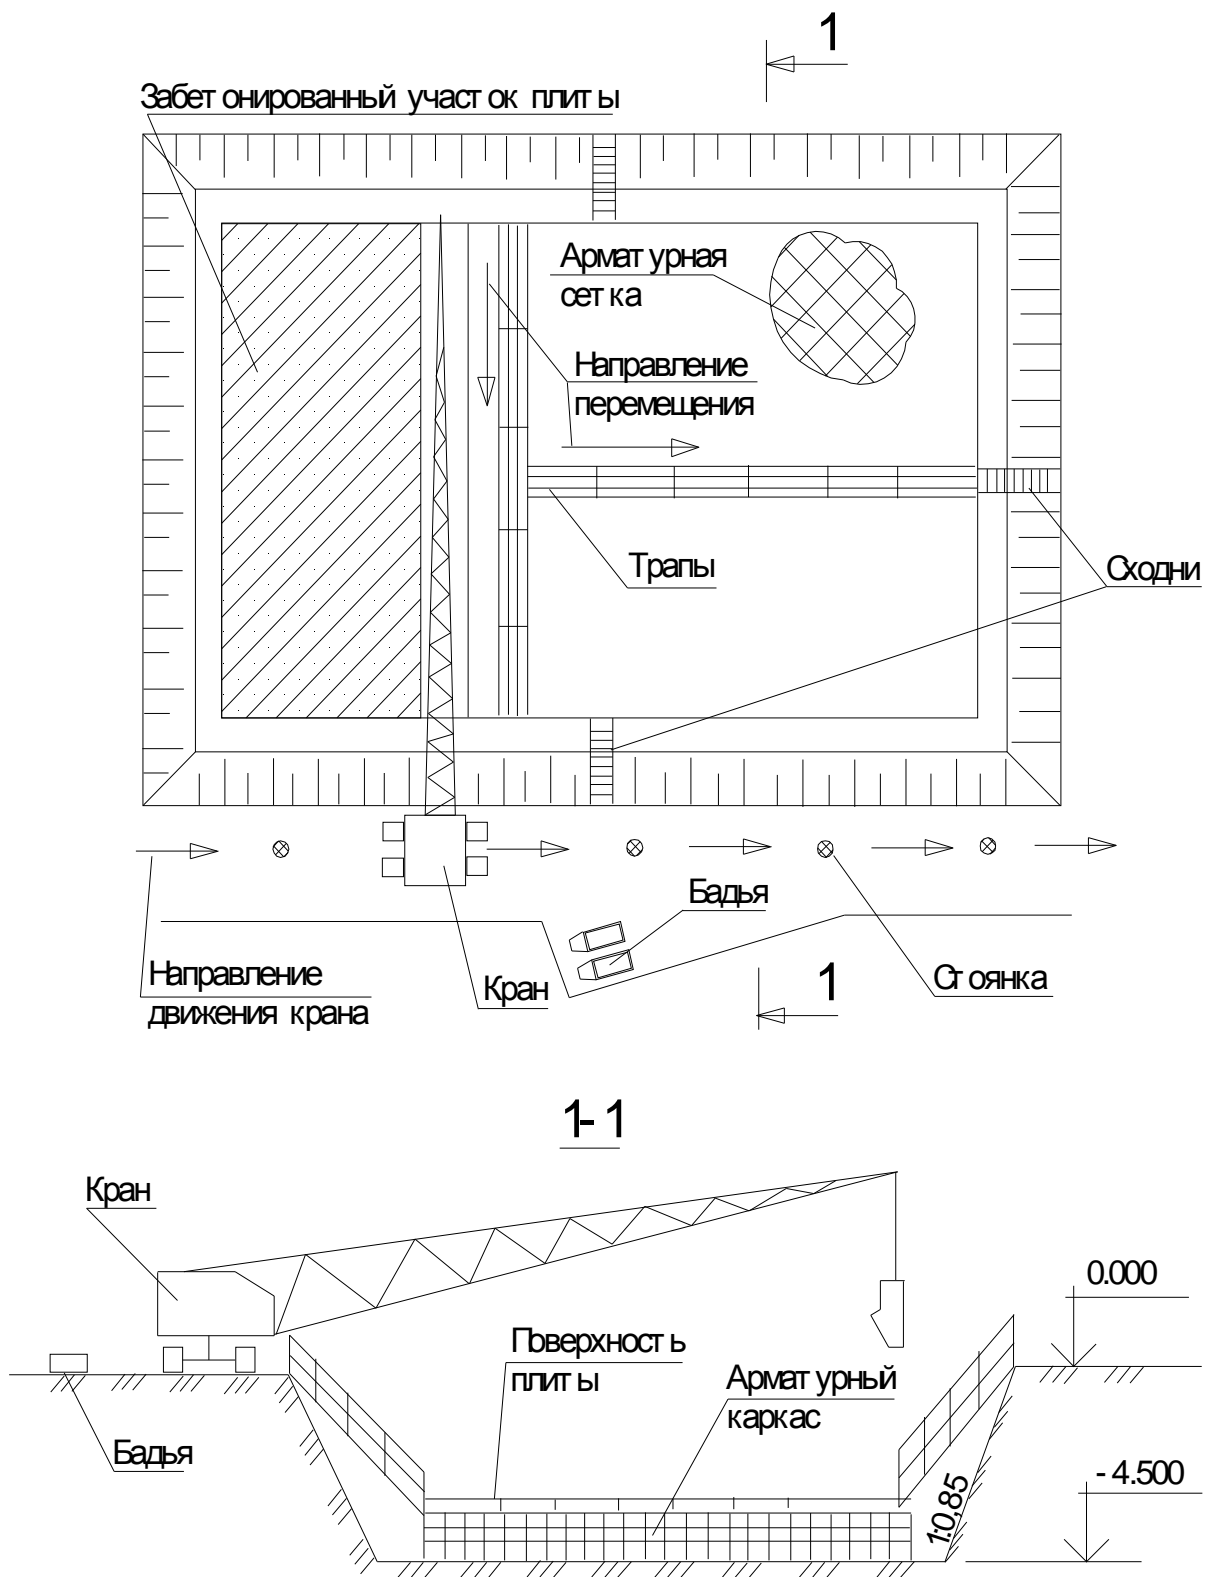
Технологическая схема бетонирования фундаментной плиты одним краном
